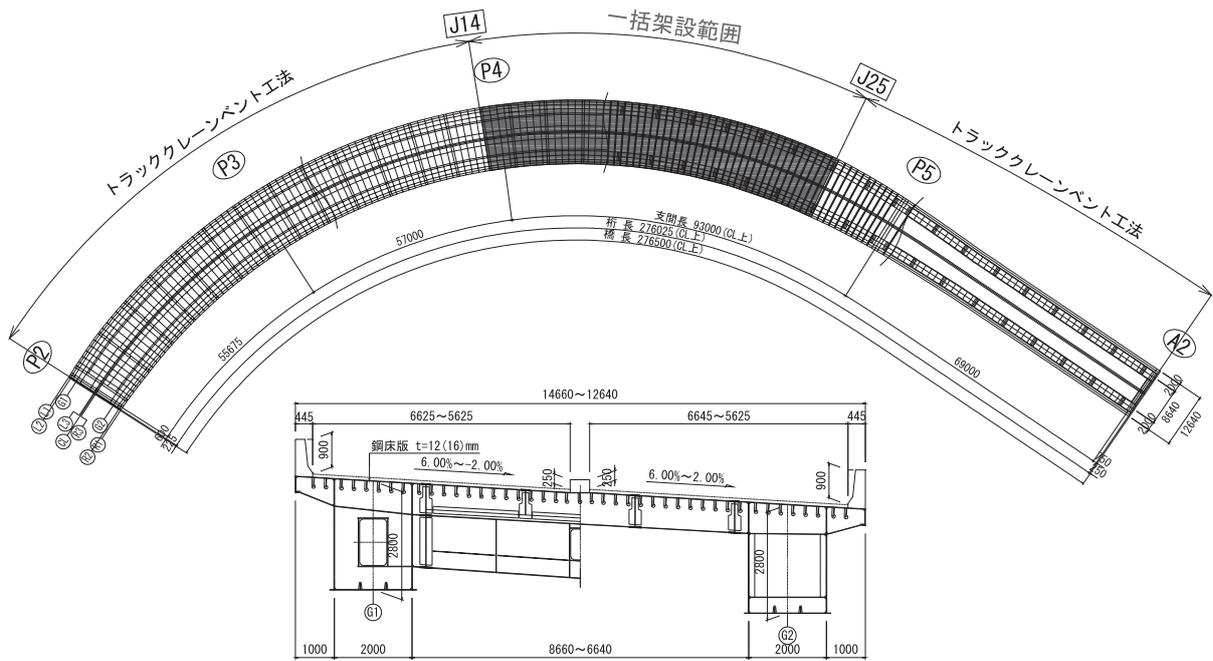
阿賀ICランプ橋一般図(平面図・断面図)
